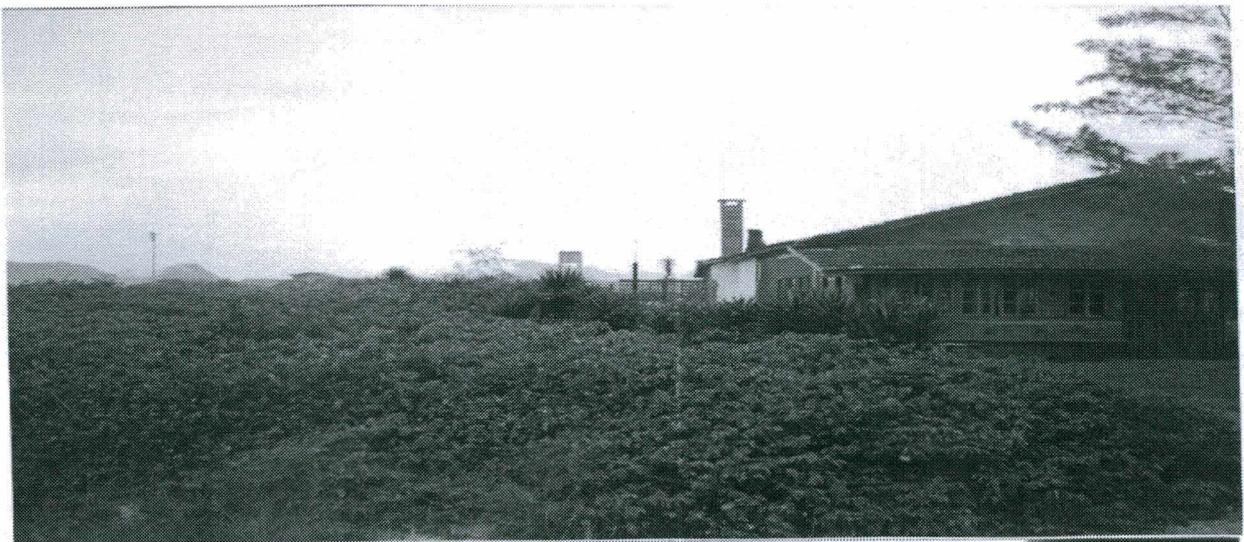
Vista da demolição parcial da antiga construção localizada sobre vegetação fixadora de dunas na Praia do Campeche, Florianópolis, SC (09.11.98).
